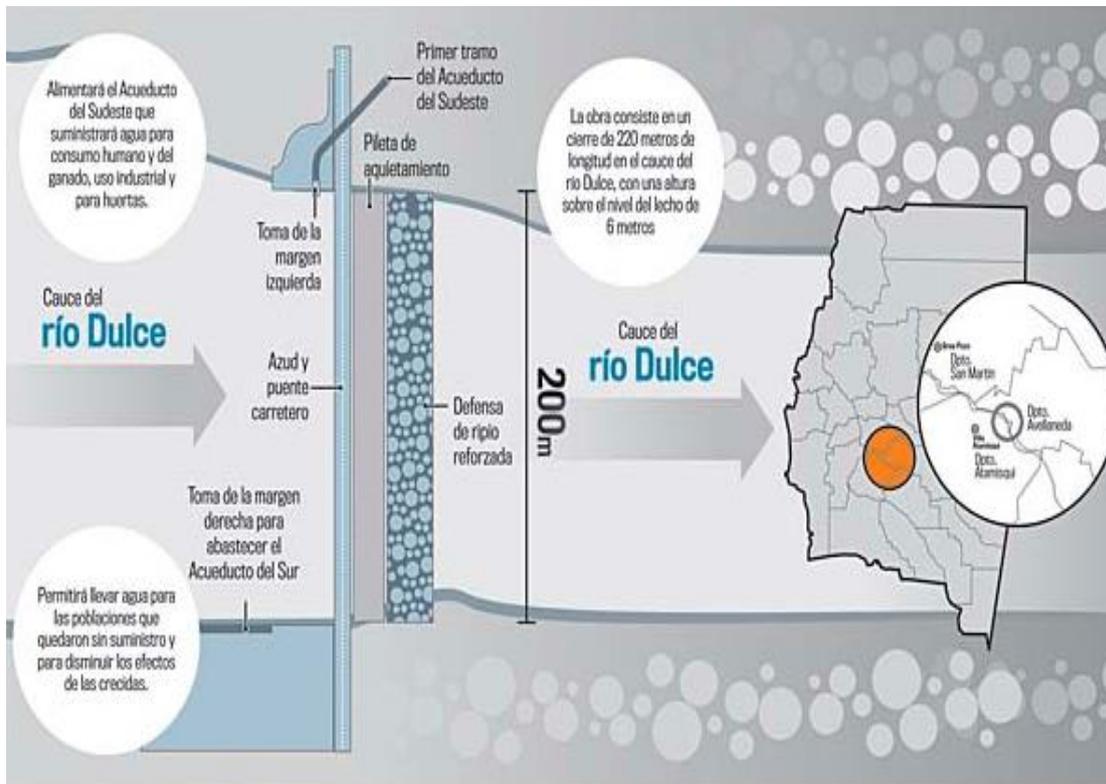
Esquema en planta del Proyecto Azud Tasigasta.
